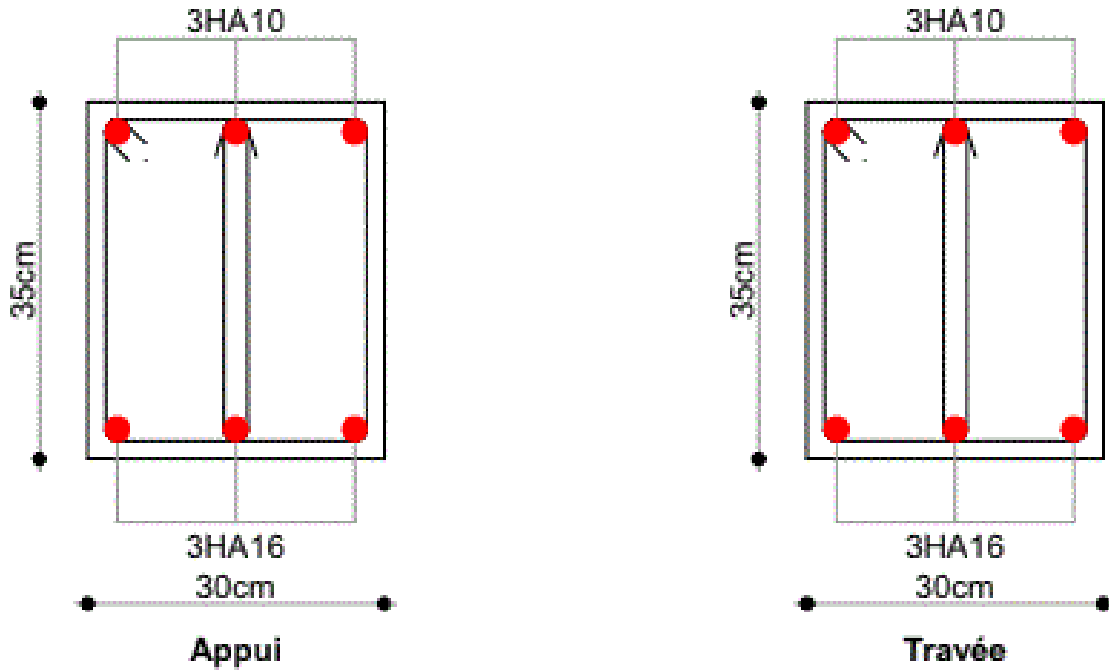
Schéma de ferrailage de la poutre de chaînage.
